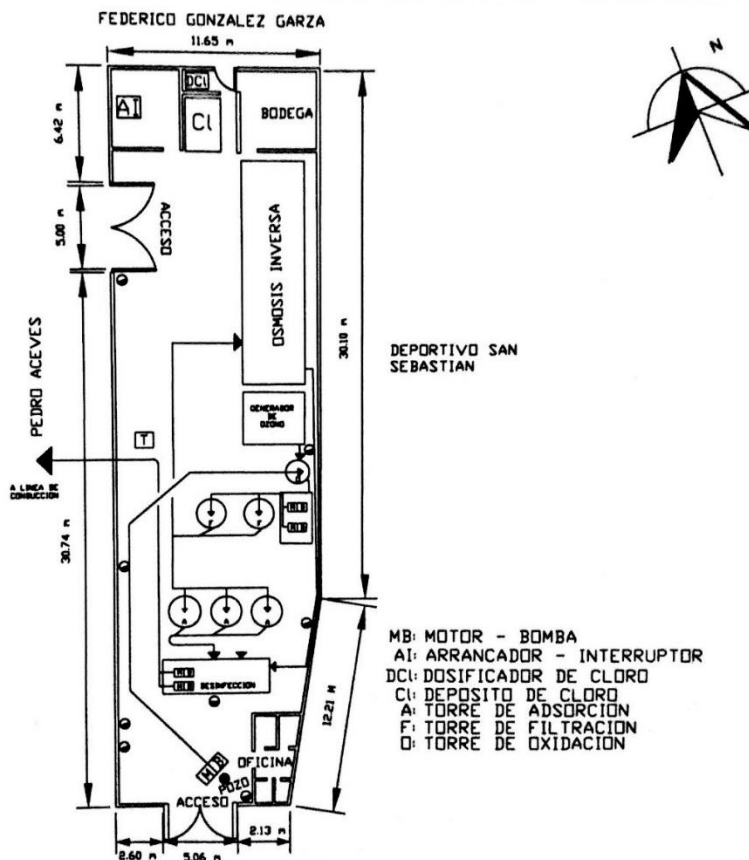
Vista en planta de la PP San Sebastián Tecoloxtitla
